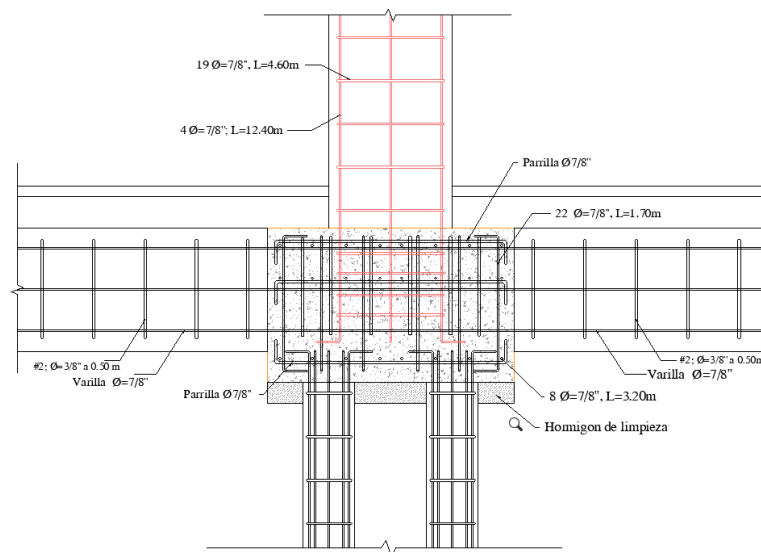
Detalle Vigas Columnas - Elaboración Propia
